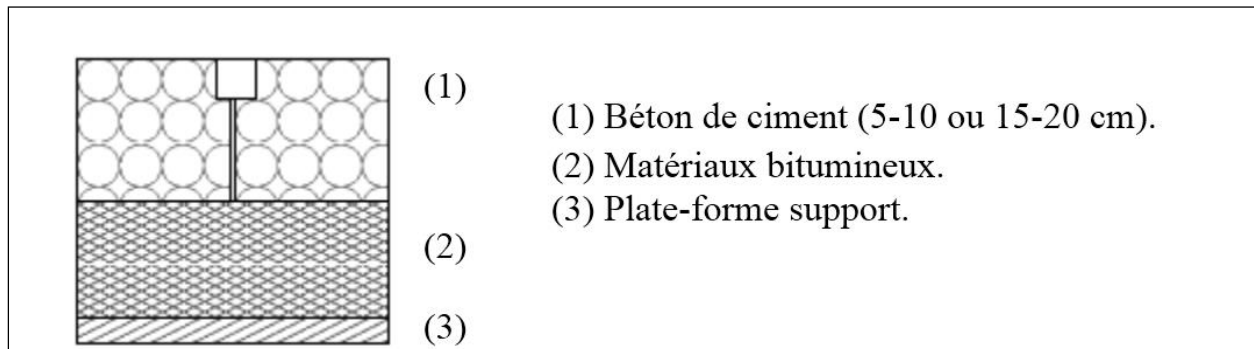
Structure d'une chaussée en béton de ciment mince collé (MEZIANI, 2008)
